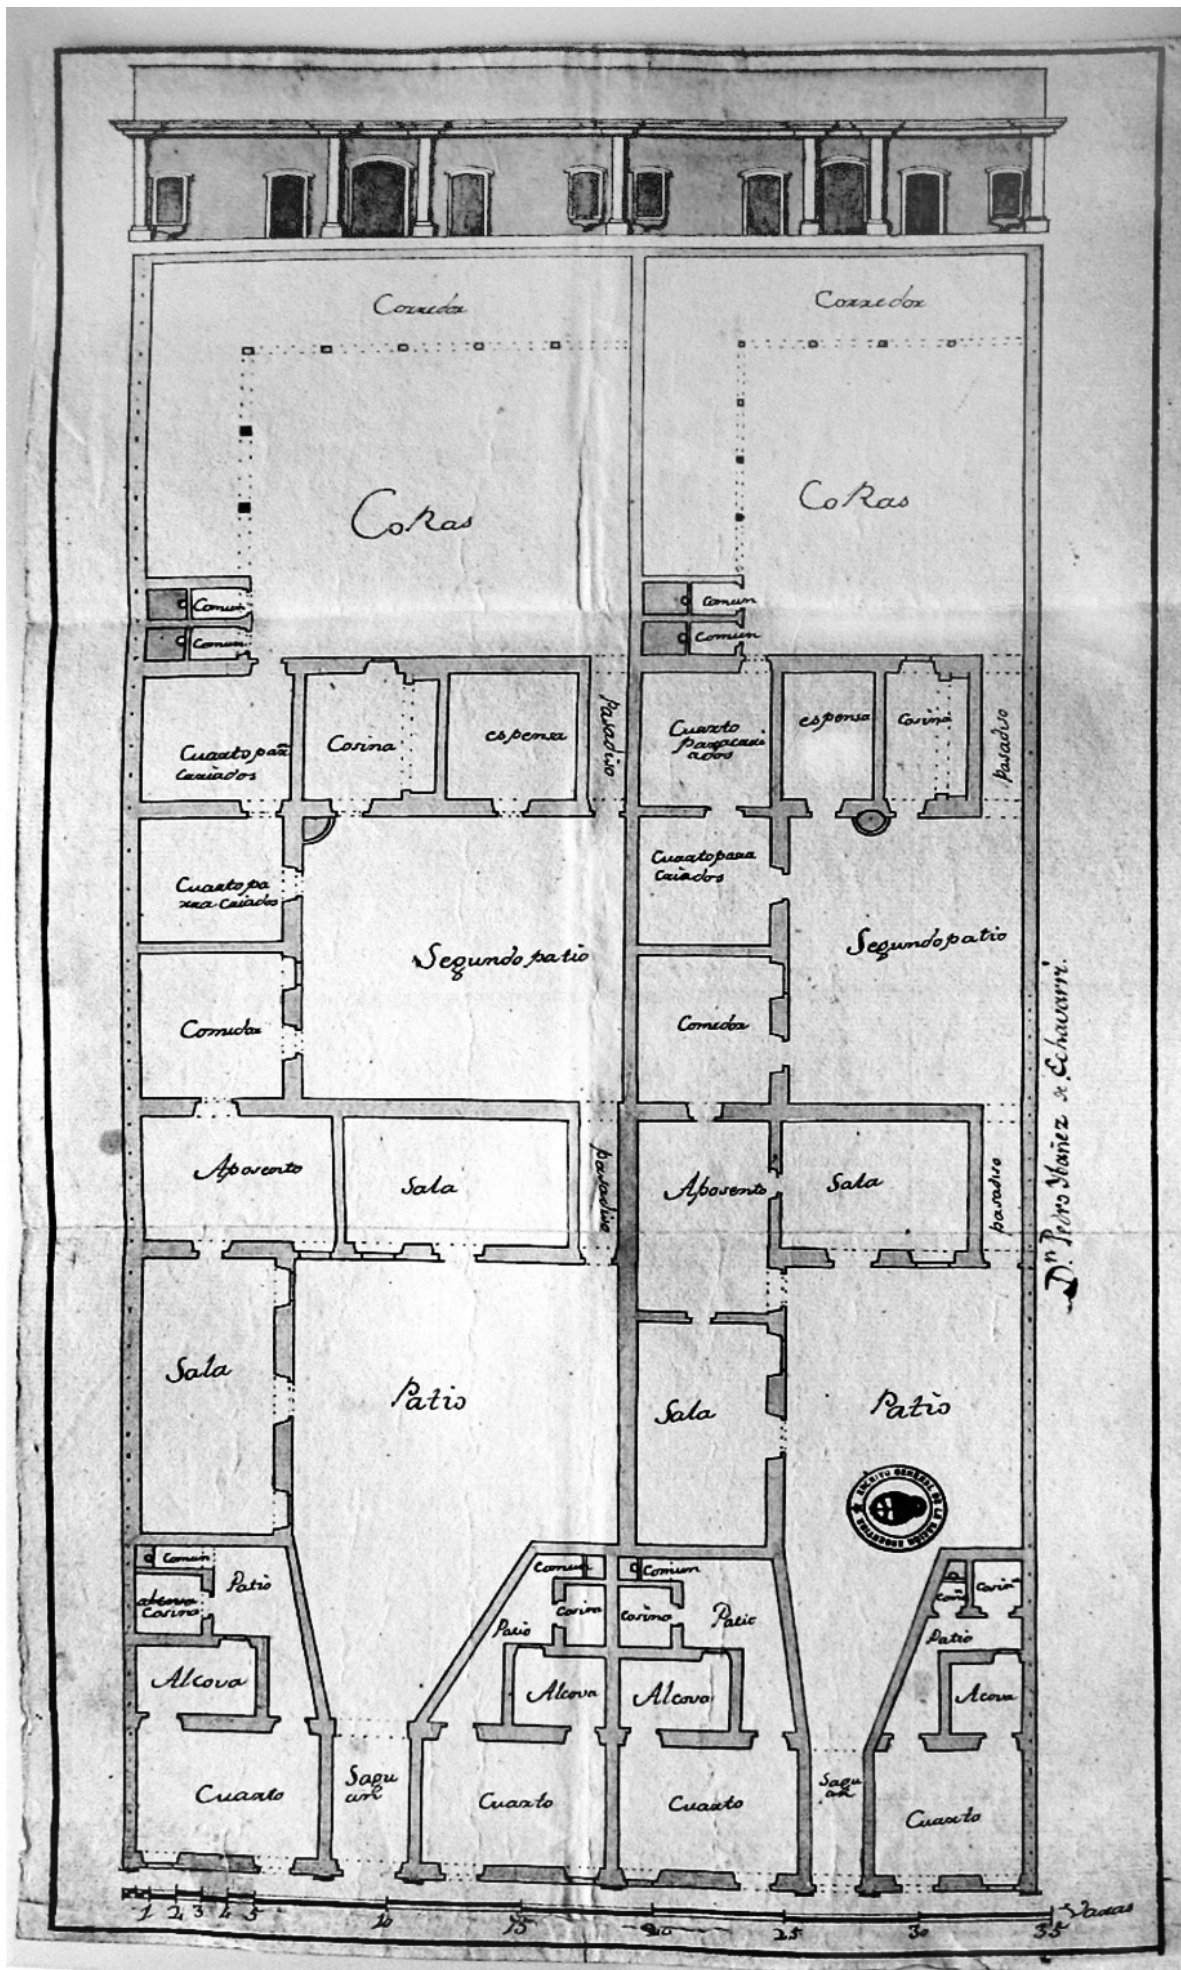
Plano de la casa de don Pedro Ibáñez Chavarría.<sup>66</sup>
